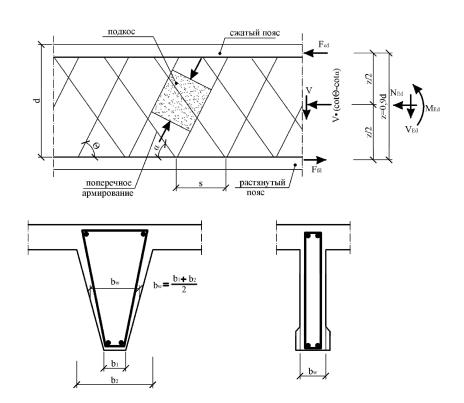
К расчету прочности железобетонных элементов при действии поперечной силы на основе стержневой моделиметодом ферменной аналогии
